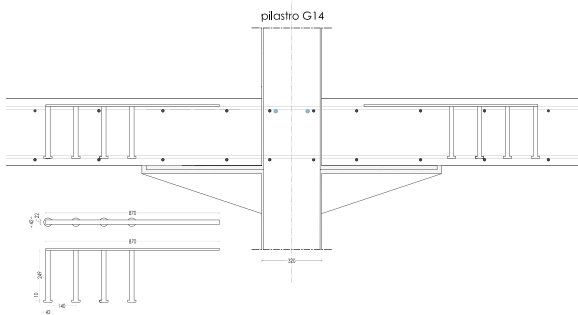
Pianta e sezioni dell'armatura tensionale a punzonamento
